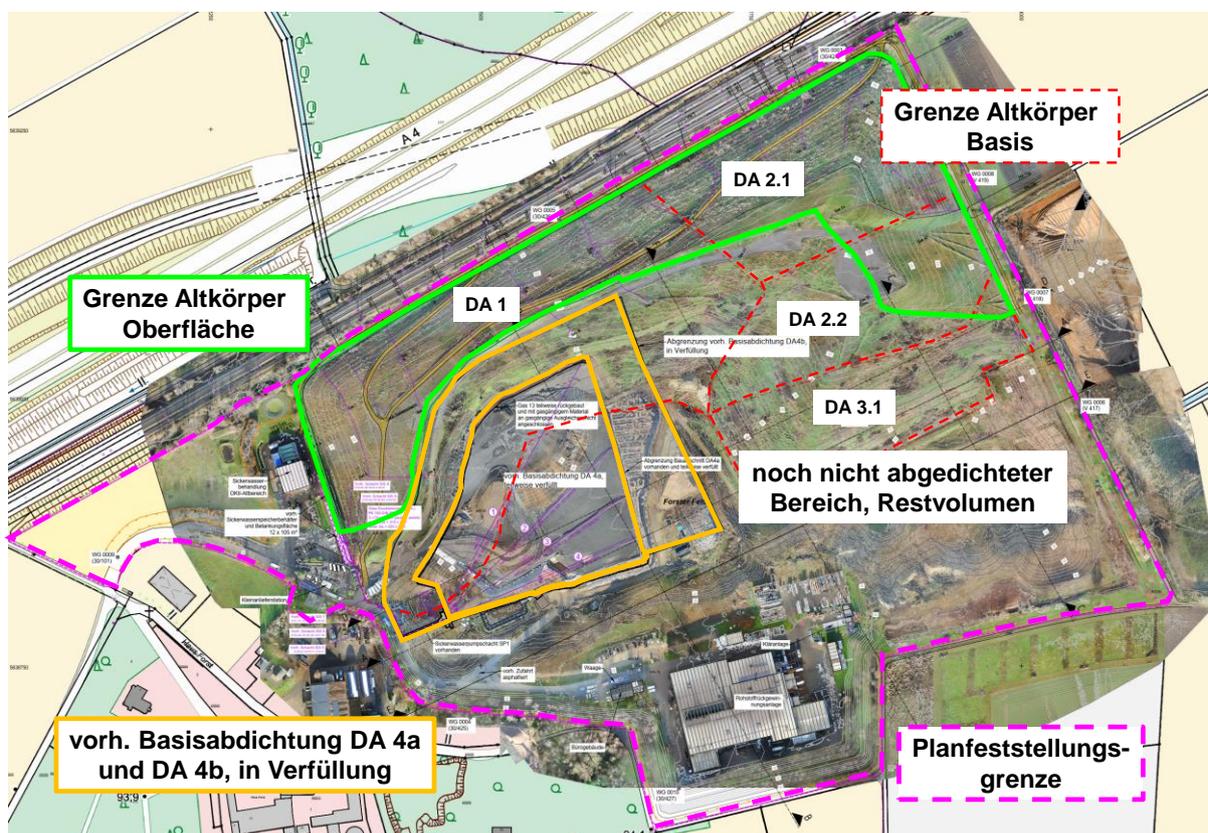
Übersicht Deponiestandort (s. auch Lageplan GP-LP-1-3.2)
